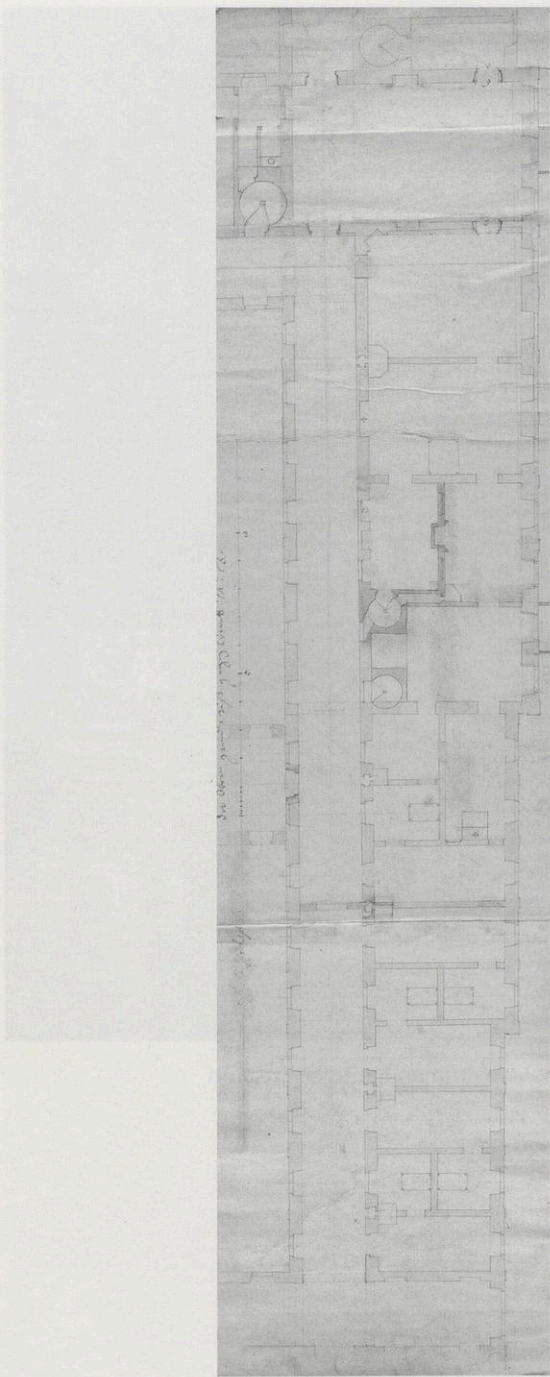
Stift Göttweig, Grundriss der Prälatur (GSSG, W c 017)
